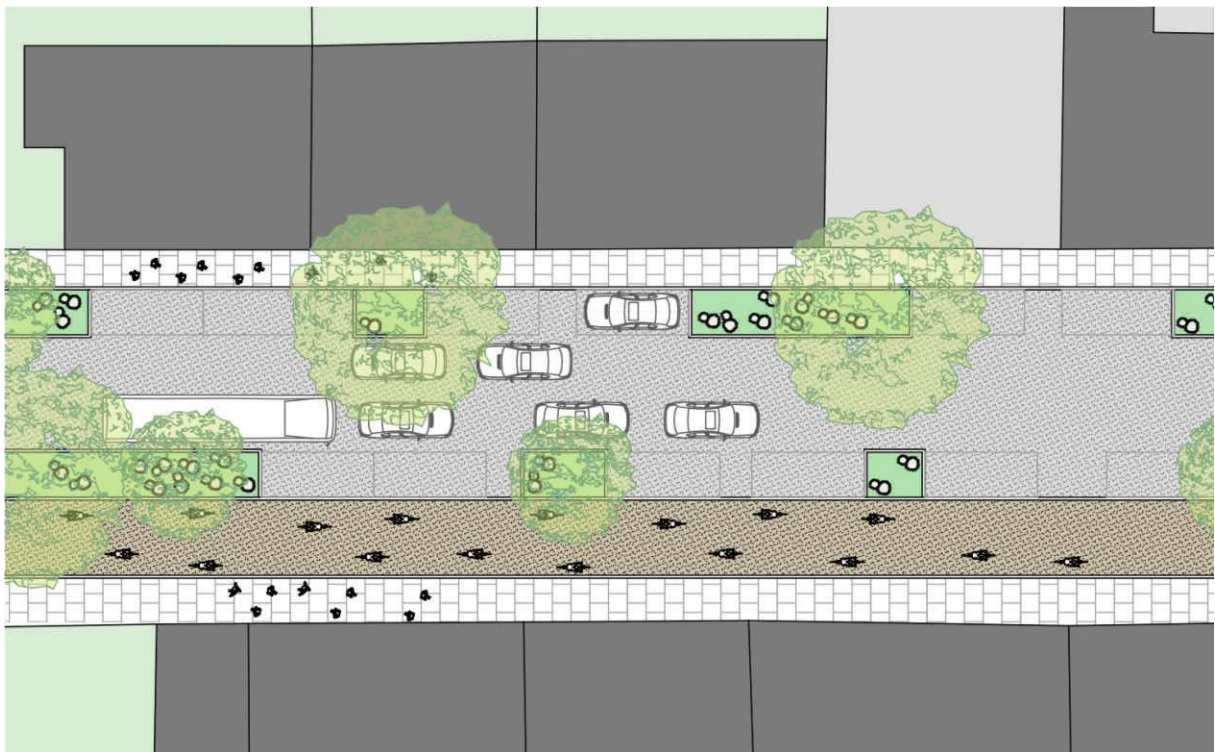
Grundriss Hauptstraße, eigene Darstellung
